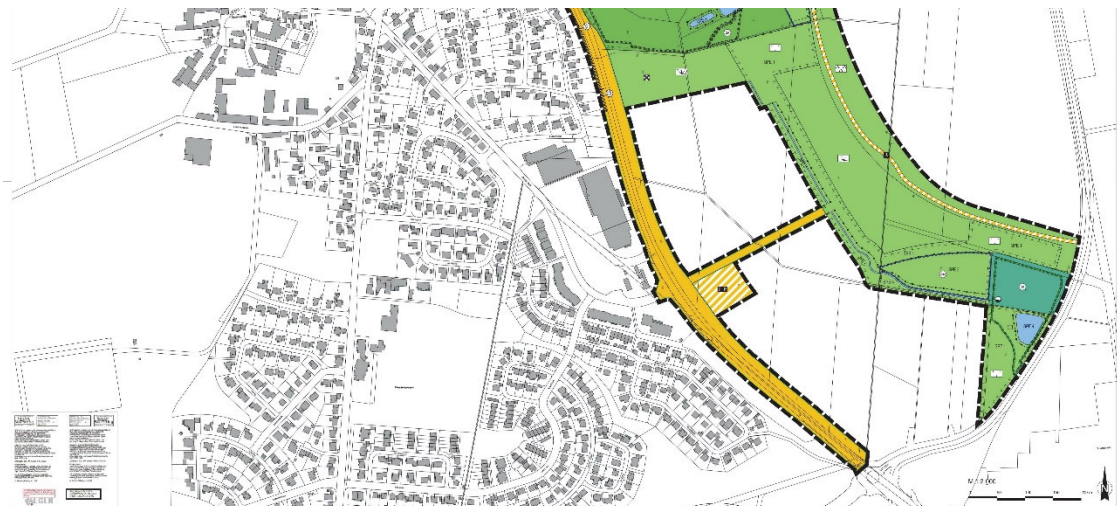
B-Plan „Infrastruktur-Bebauungsplan Sonnenkamp“ (Ausschnitt Nordsteimker Straße)
